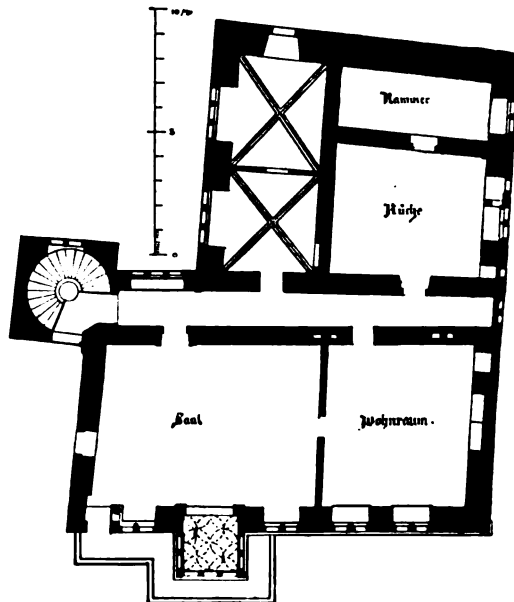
Lorch. Hilchenhaus. Grundriss.
